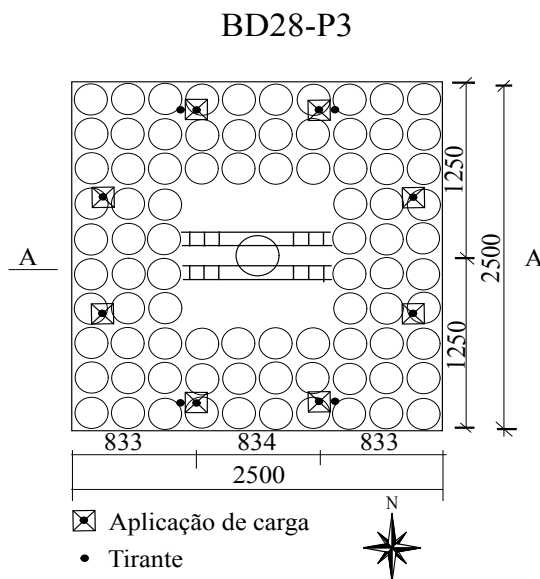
Arranjo armadura de cisalhamento laje BD28 – P3, Lima (2015)
